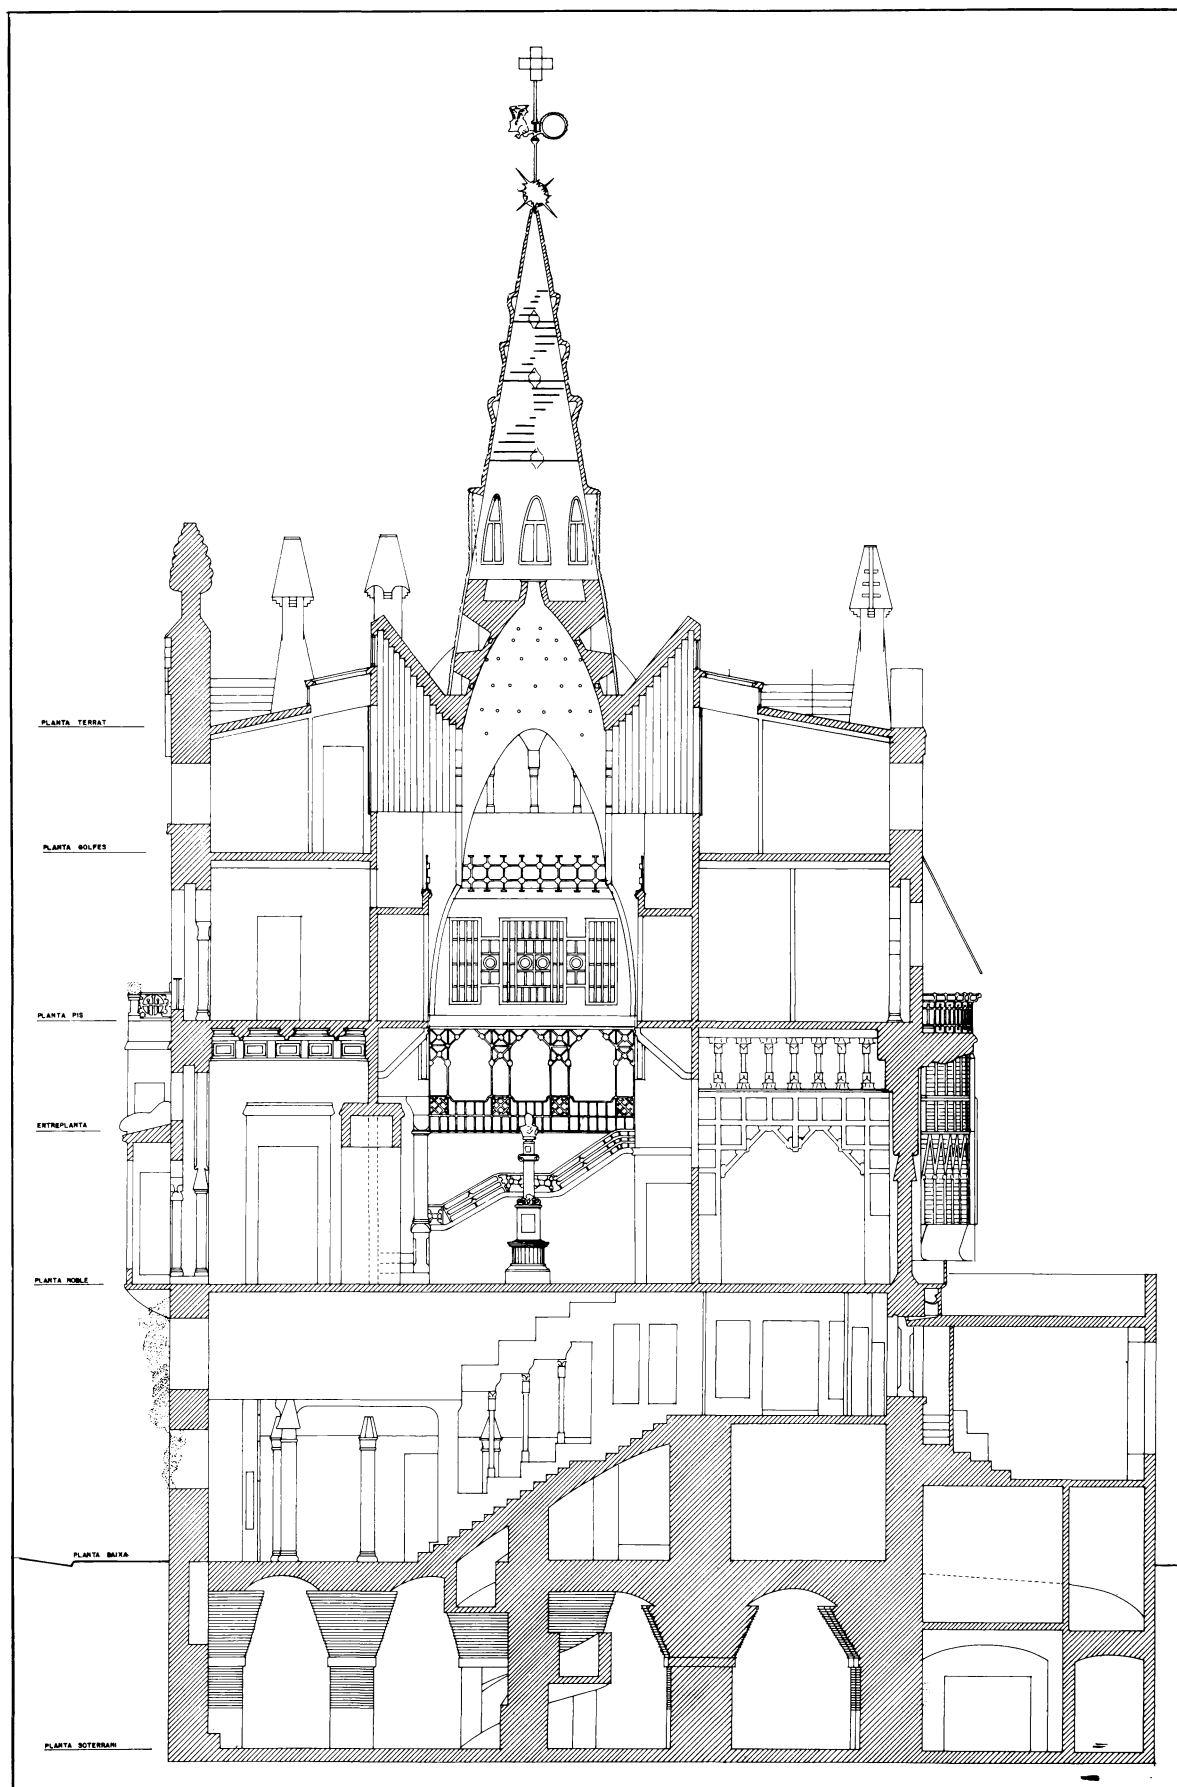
Sección del Palau Güell perpendicular a las fachadas.
